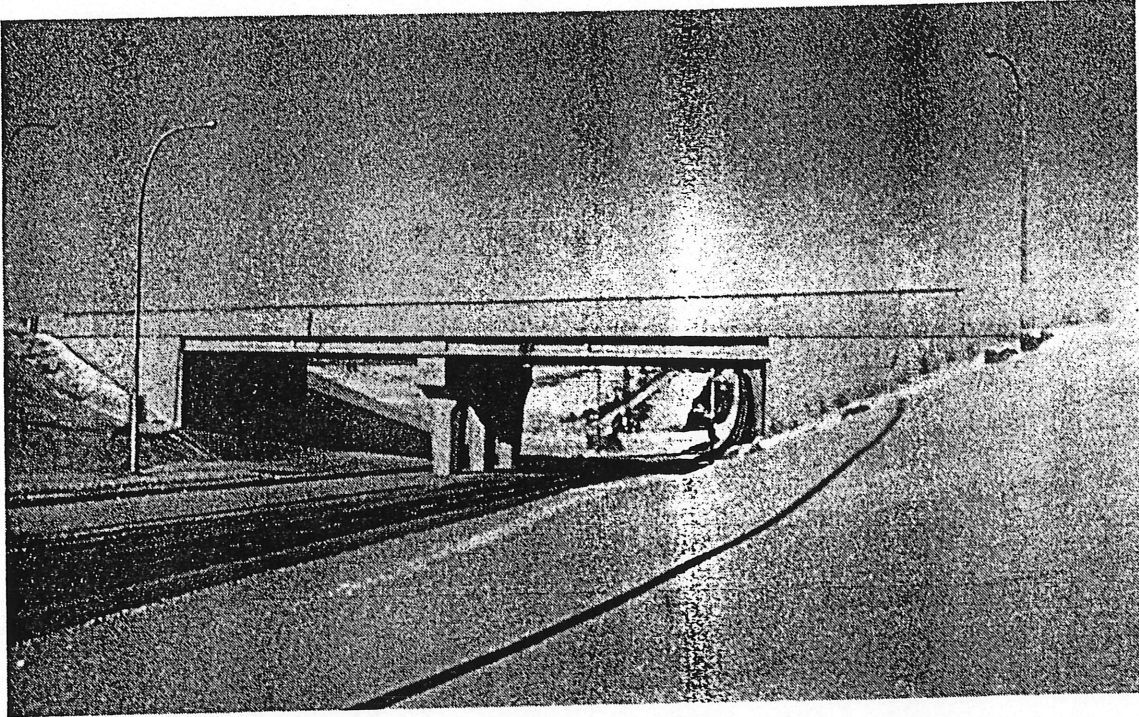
Le Calgary Beddington Trail Bridge (WADE et coll., 1993)
